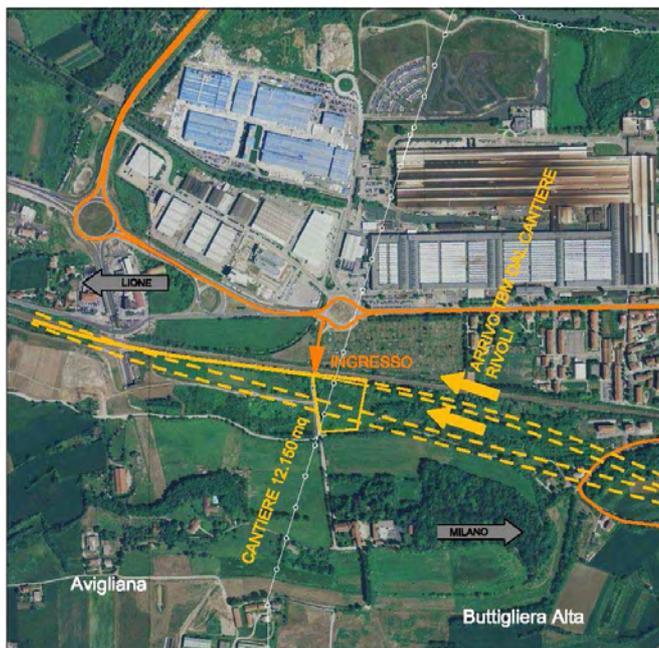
Cantiere di arrivo delle TBM - Rivoli
